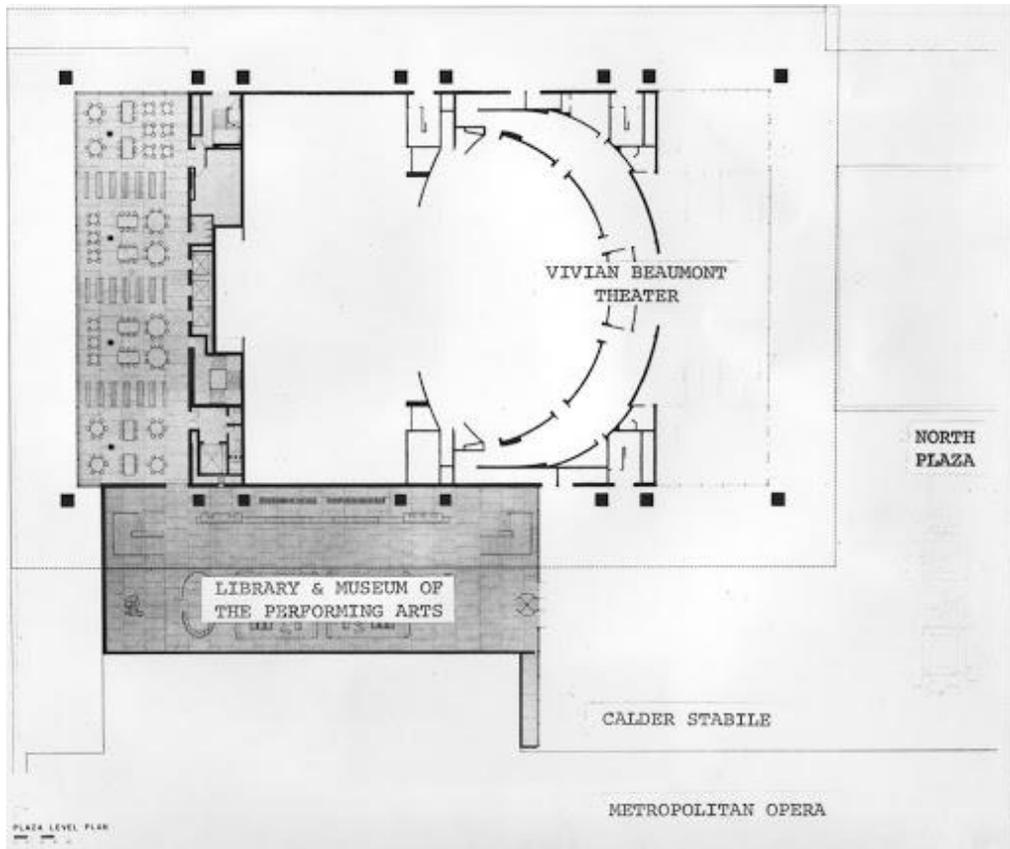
Plano de planta baja - *Vivian Beaumont Theatre* (1965)
